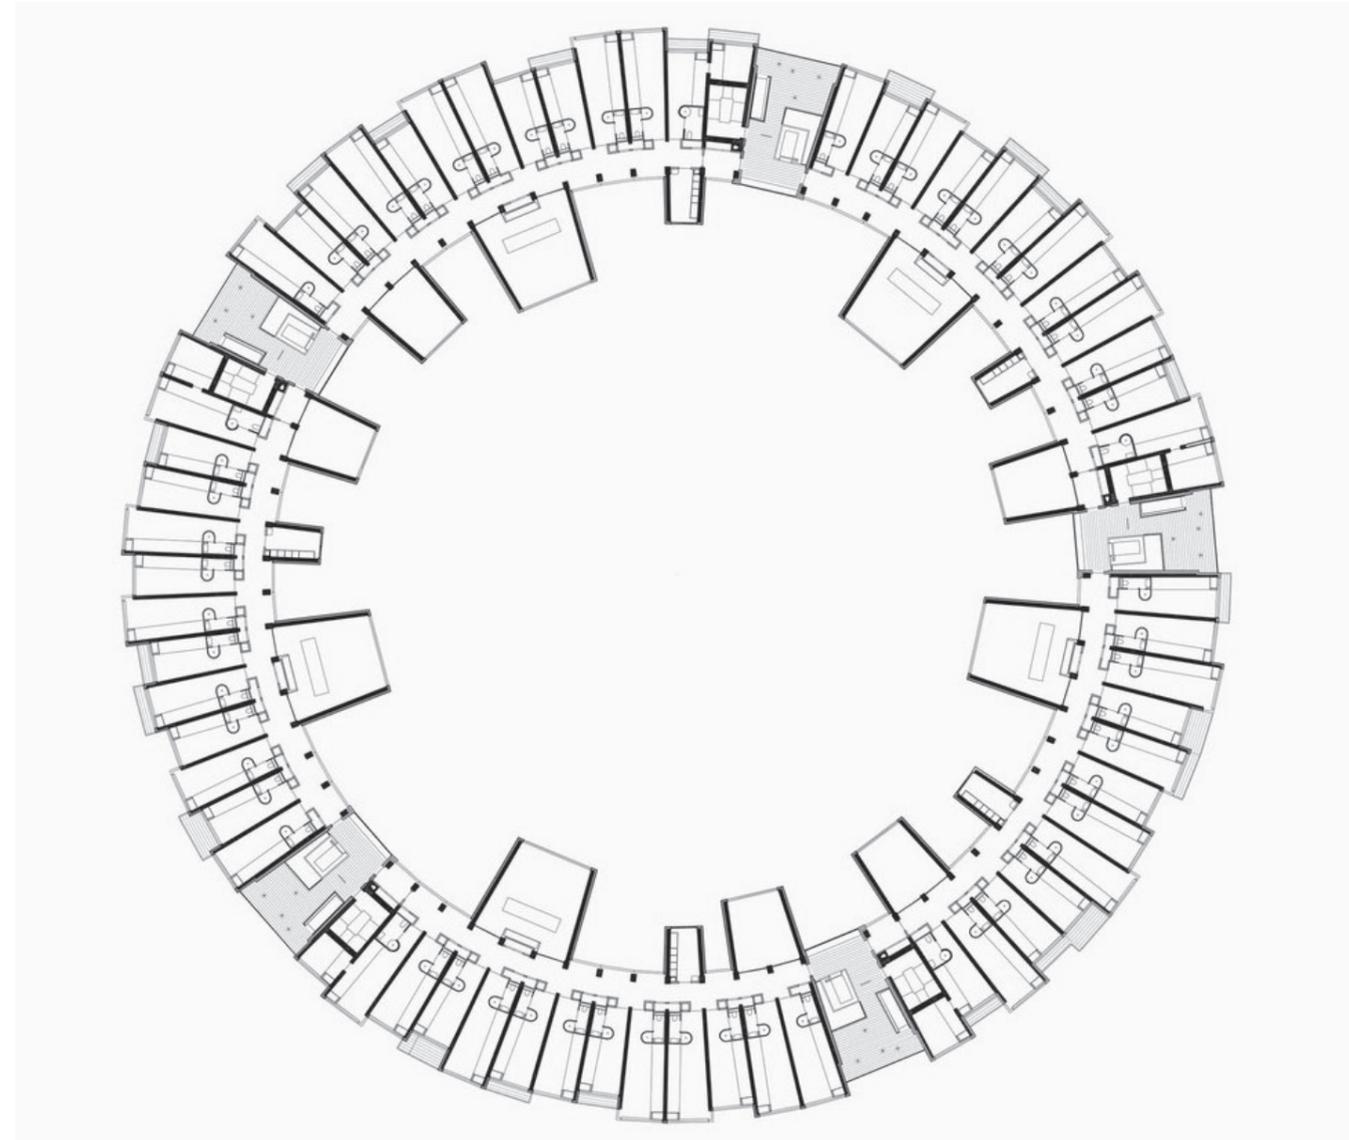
Grundriss 4.OG Tietgenkollegiet, ohne Maßstab (Lundgaard & Tranberg Arkitekter o.J.)
